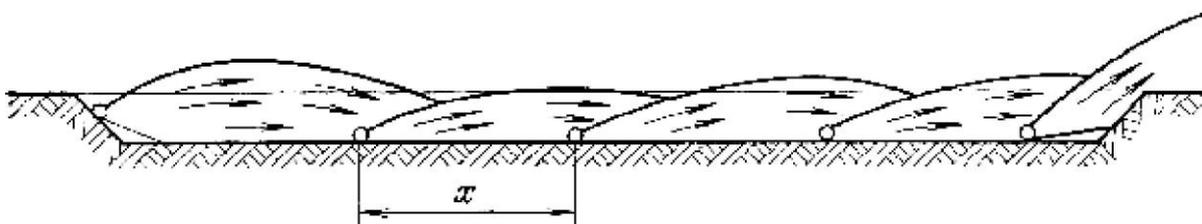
Схема последовательной (каскадной) работы вентиляторных установок
